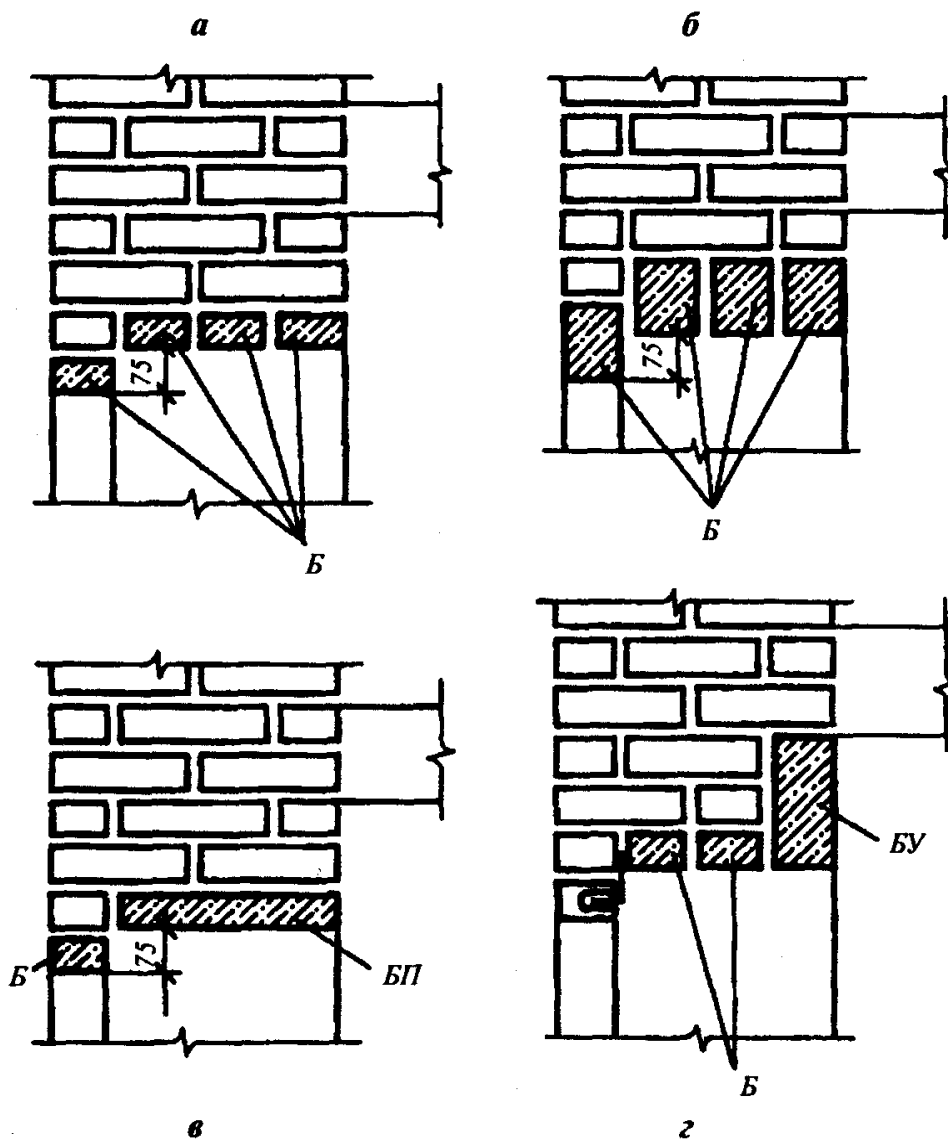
Сборные железобетонные перемычки: а, б – брусковые (тип Б), в – плитные (тип БП), г-балочные (тип БУ)
